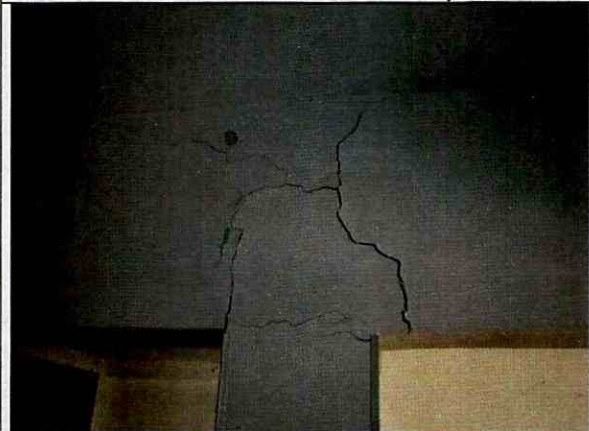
Fisuras y grietas en elementos estructurales.
